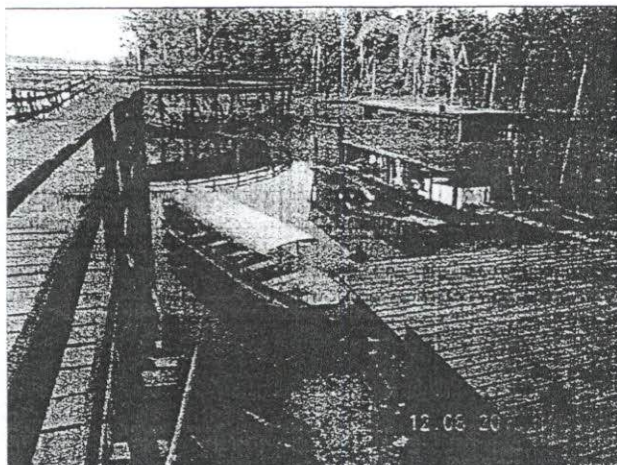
Acoradouro construído pelos moradores - Observar falta de rampa de acesso.
